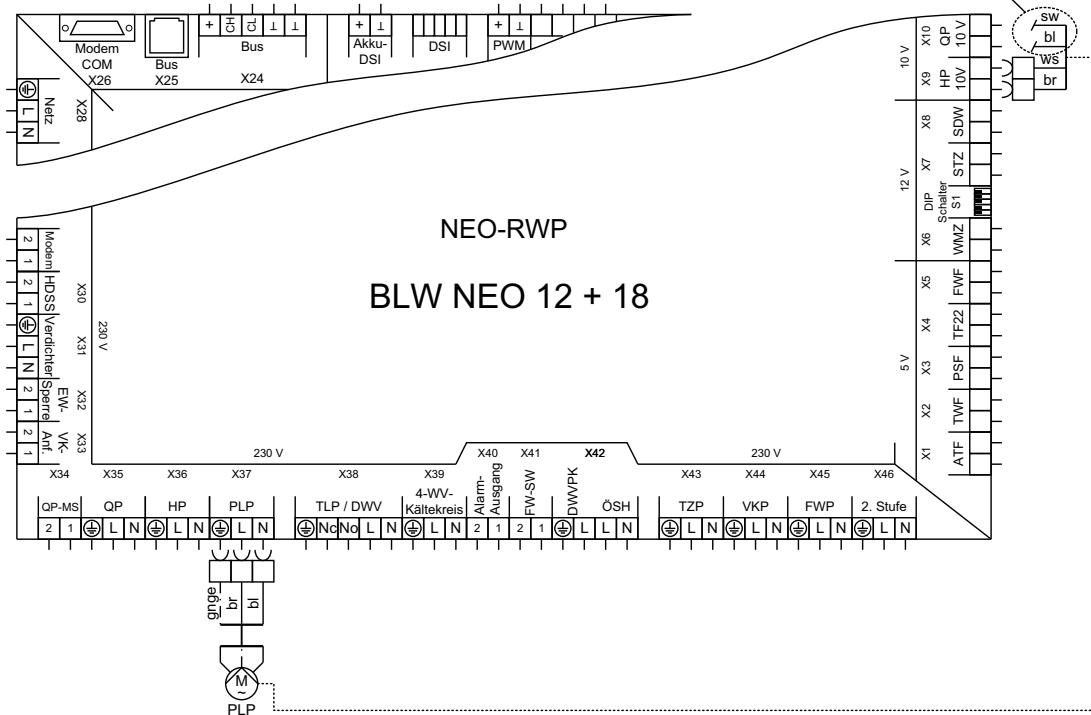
09149: Anschlussplan Umwälzpumpe BLW NEO 12 + 18
